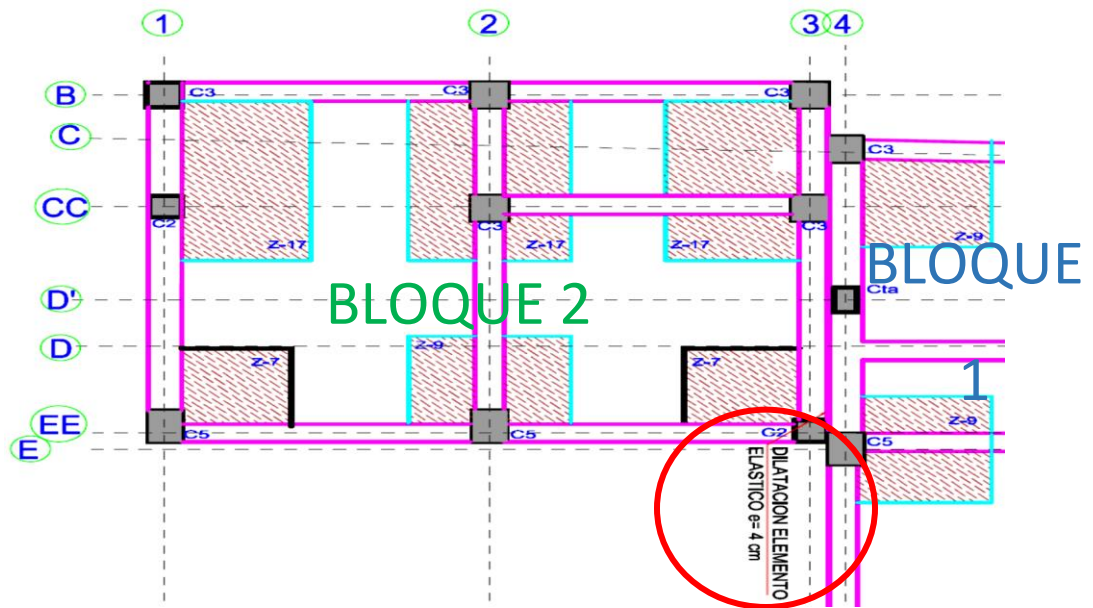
PLANTA DE CIMENTACION Y JUNTA DE DILATAcion
